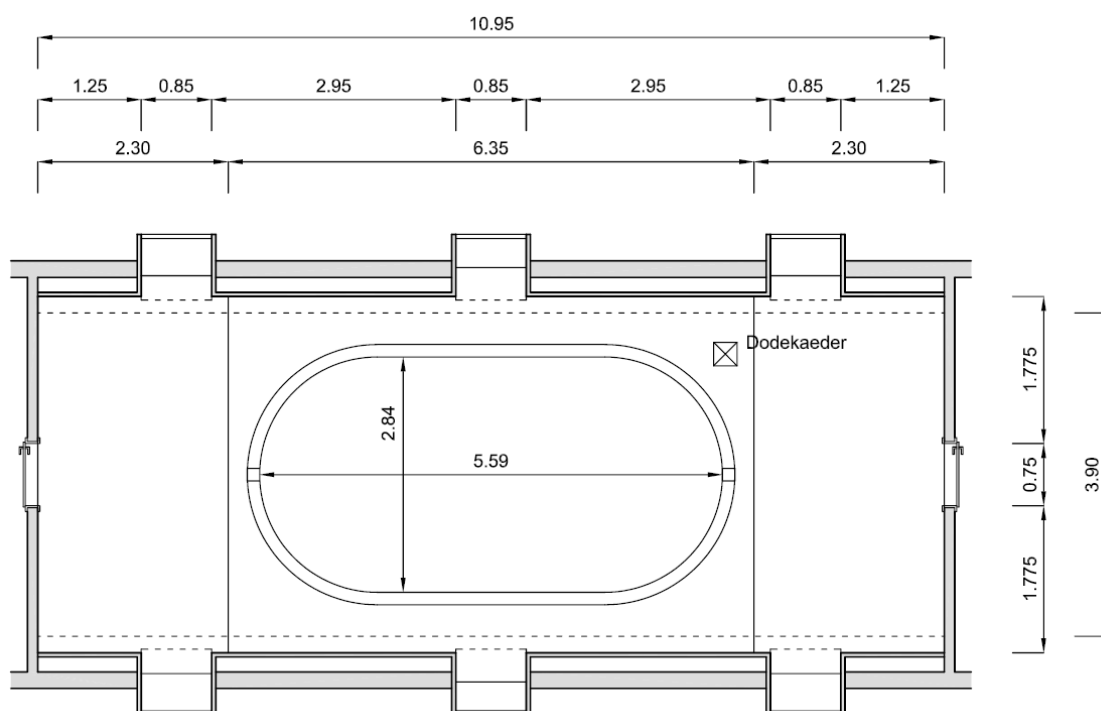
Grundriss des Galeriegeschosses über dem Sommersaal mit Lage der Messposition
